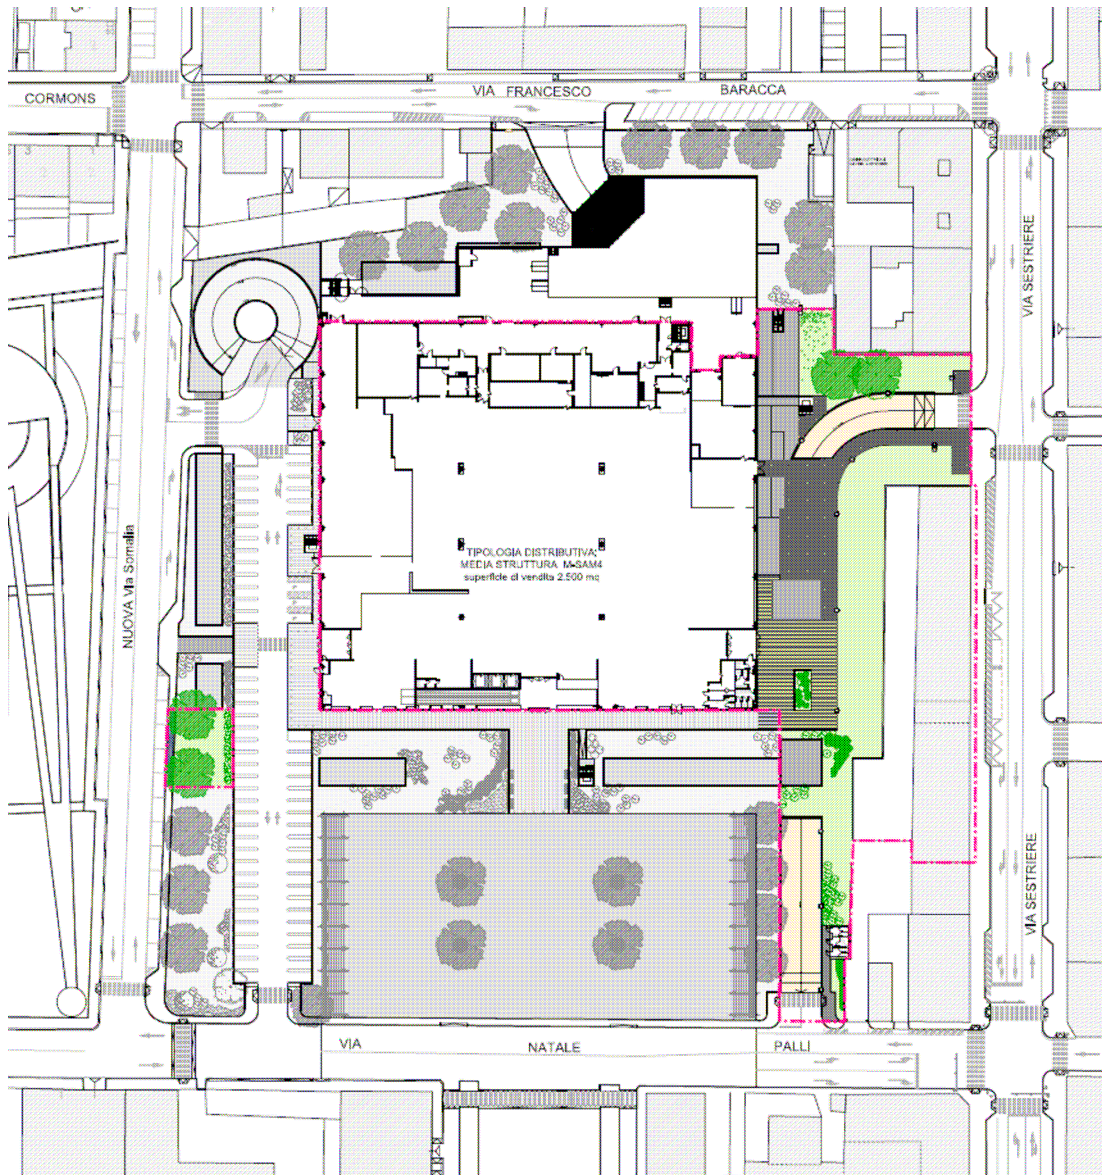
/III - Planimetria dello stato di fatto dell'area
